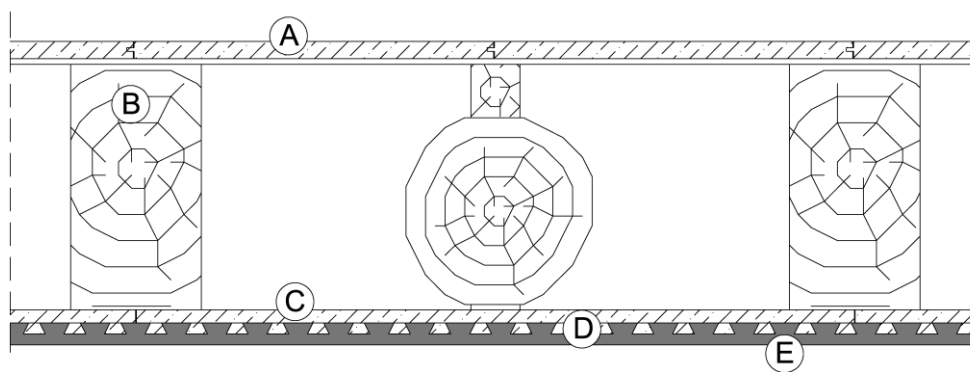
Corte esquemático da solução tipo usada em pavimentos da Baixa portuense. [27]
